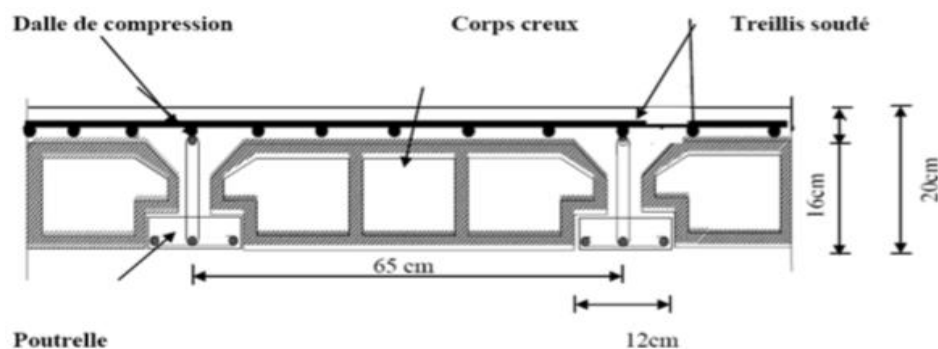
Schéma descriptif d'un plancher en corps creux
